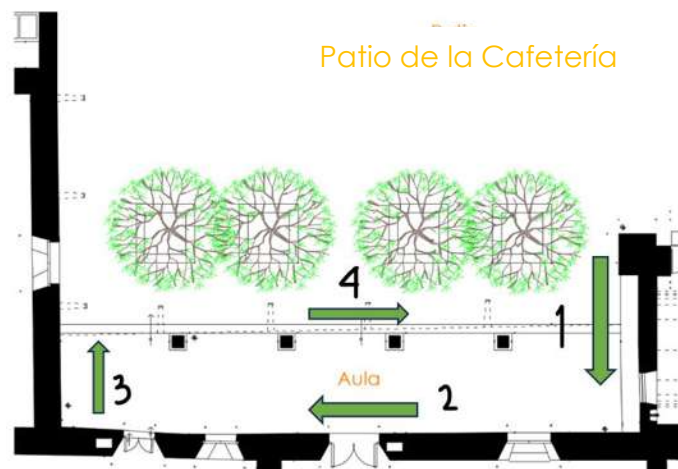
Planta de mayor deterioro, orden levantamiento arquitectónico.
